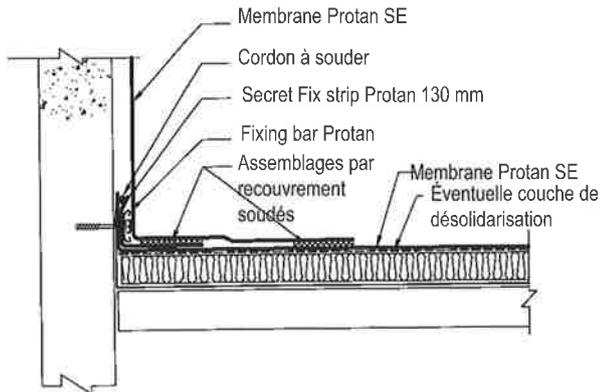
Fixation au droit de l'angle du relevé avec Secret Fix Strip
